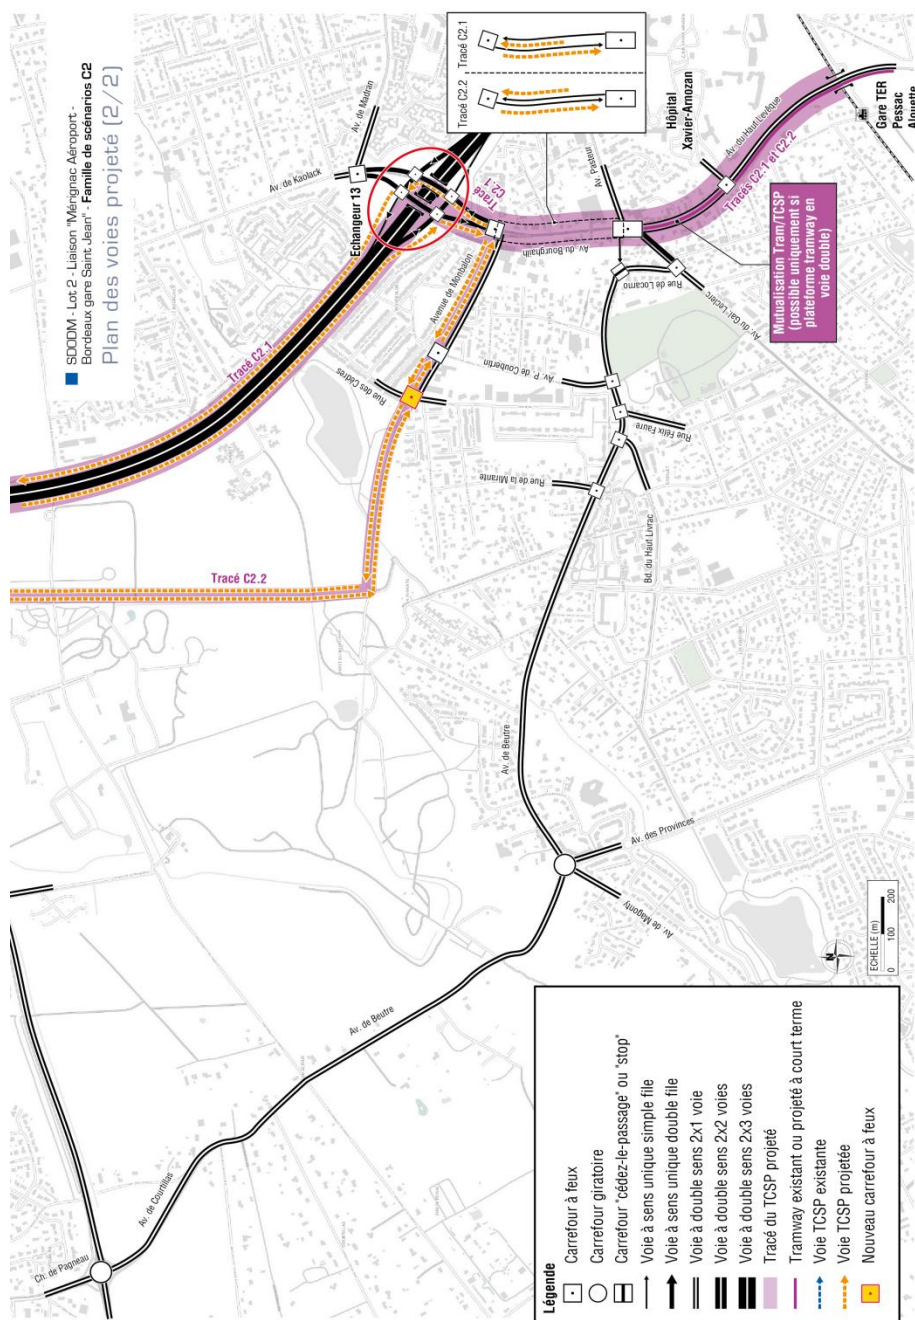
Scénarios C2 Plan des voies projetées 2/2
